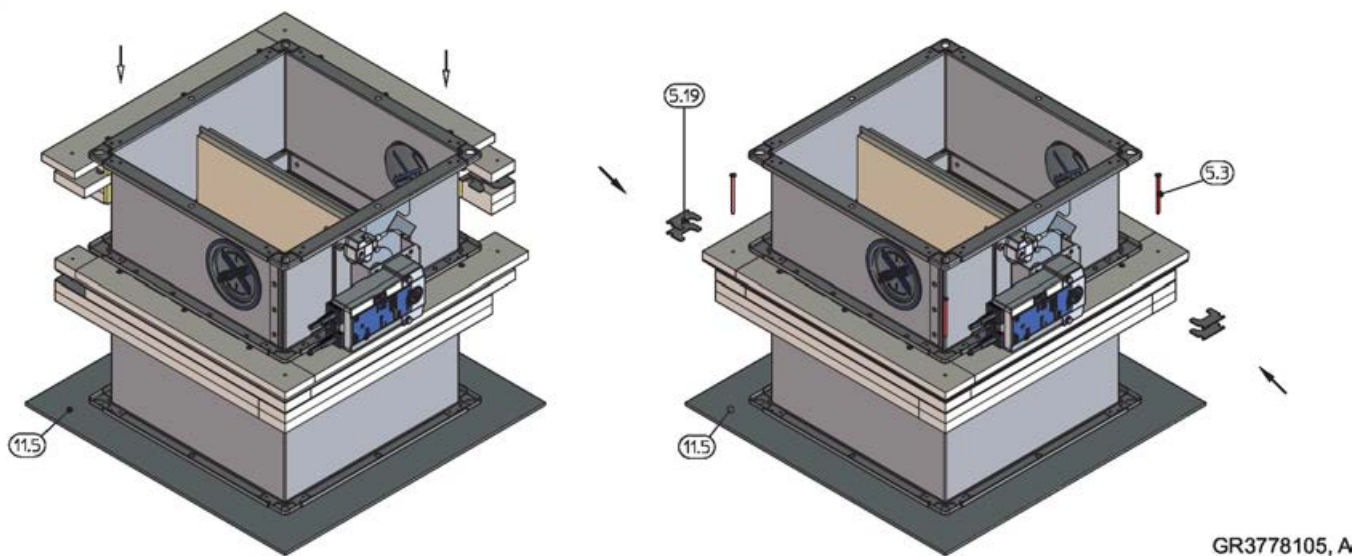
Kit d'installazione WE per installazione a secco – montaggio
